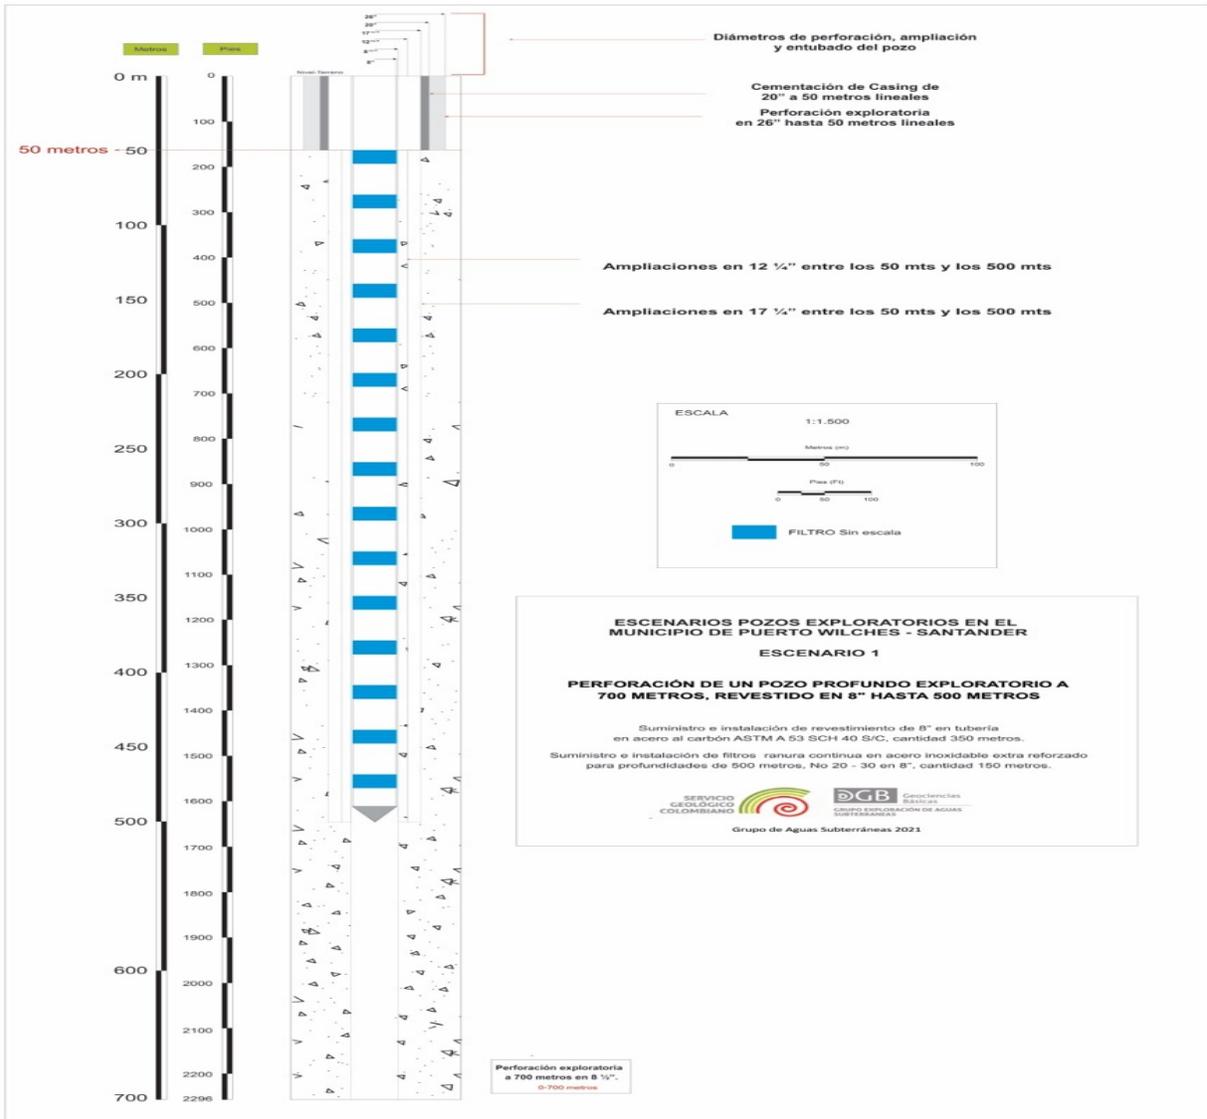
Fuente: Esquema Escenario de Diseño N° 1 - Pozo SGC PUERTO WILCHES 1
